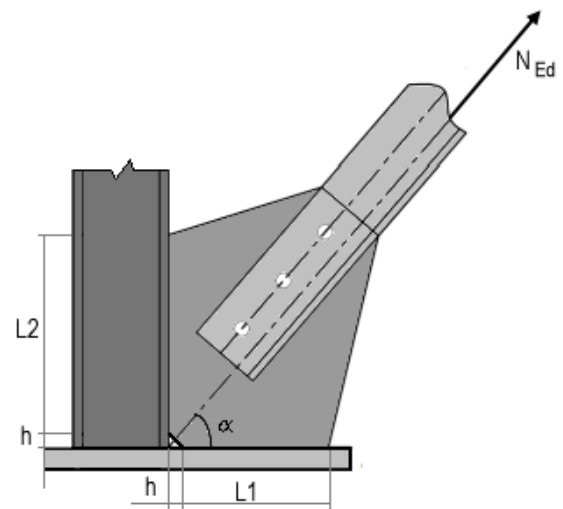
Soudure d'une barre de contre-ventement
